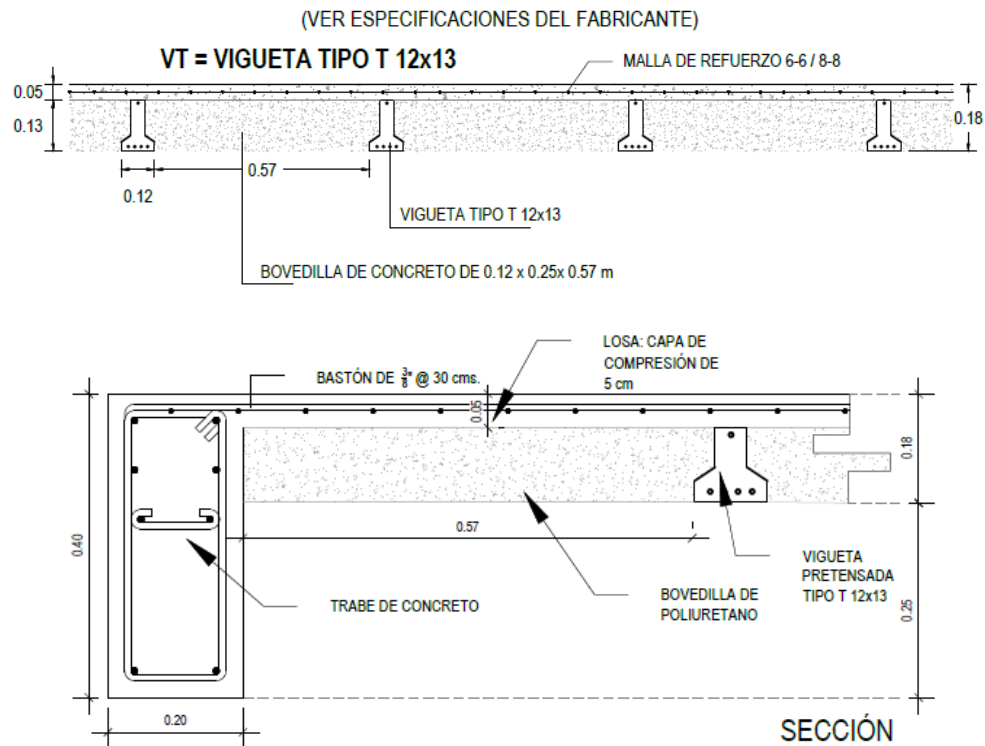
Losa de concreto de vigueta y bovedilla, modelo vigueta pretensada (elaboración propia) (véase en anexos).
